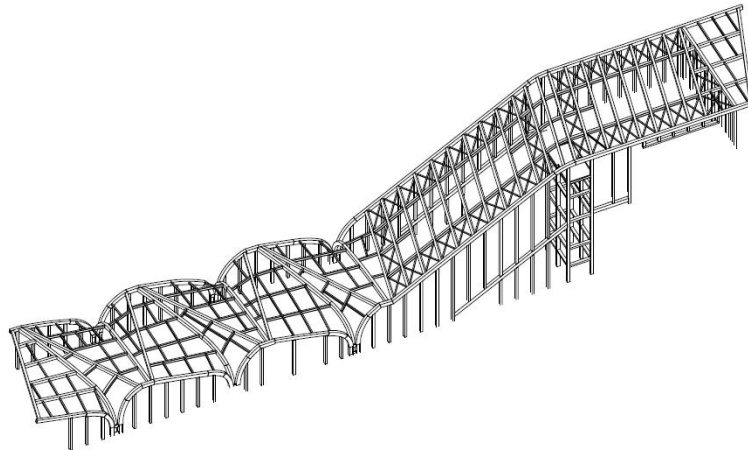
Cubierta del Shelter East de la estación de Al Wakra
